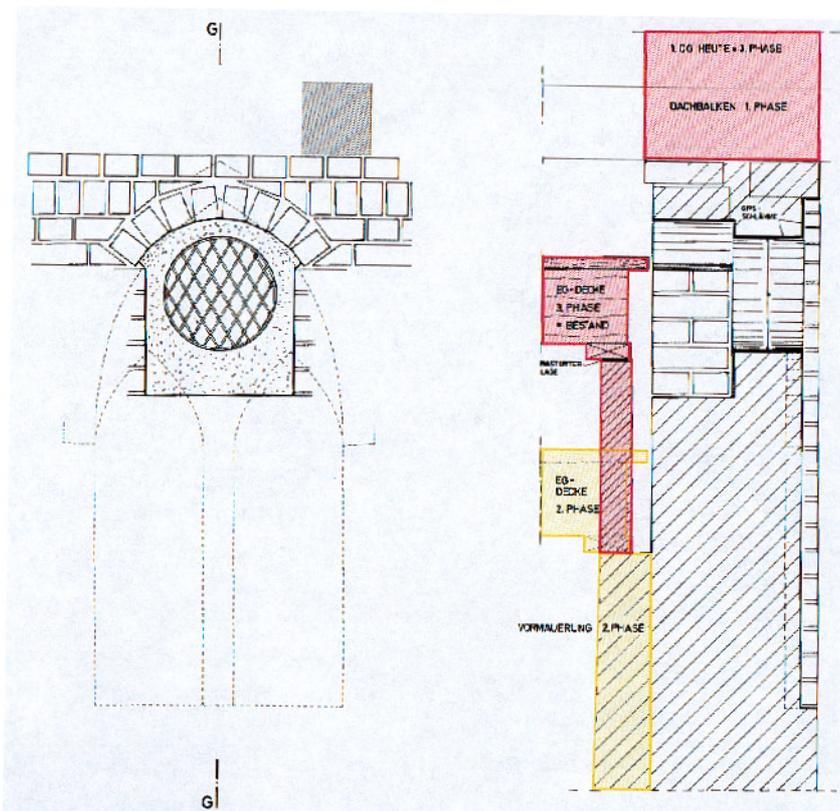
Detailplan Flachbogennische mit Oculus, Ansicht raumseitig und Schnitt (Plan 65)
